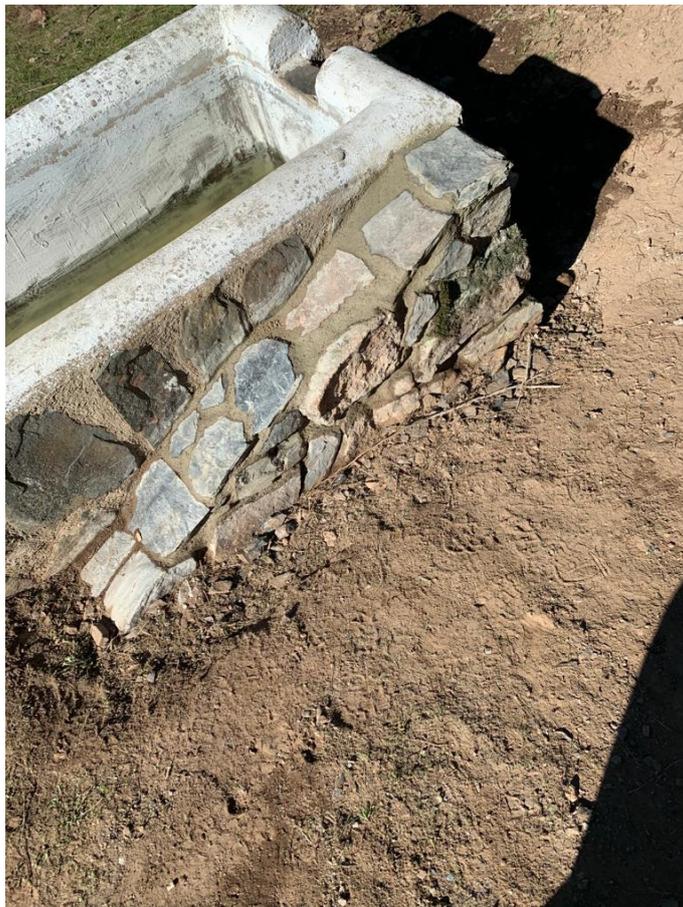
Rampa de acceso de anfibios construida en uno de los pilares.
